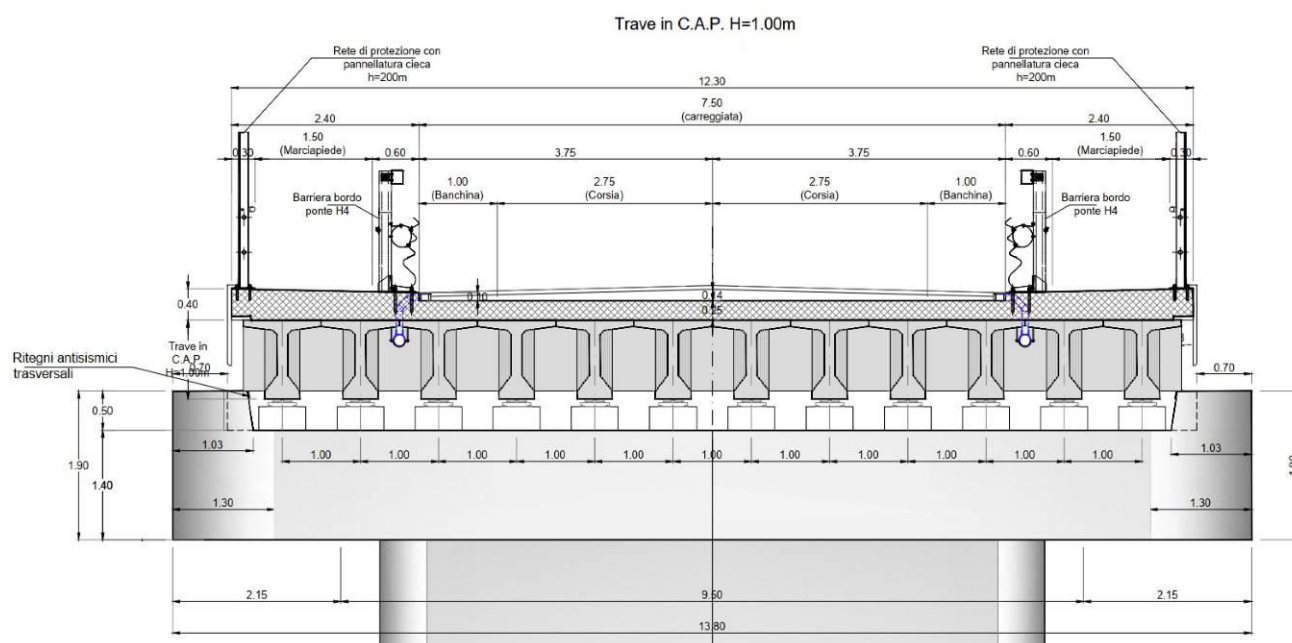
Sezione trasversale impalcato in c.a.p. (sezione in campata)
